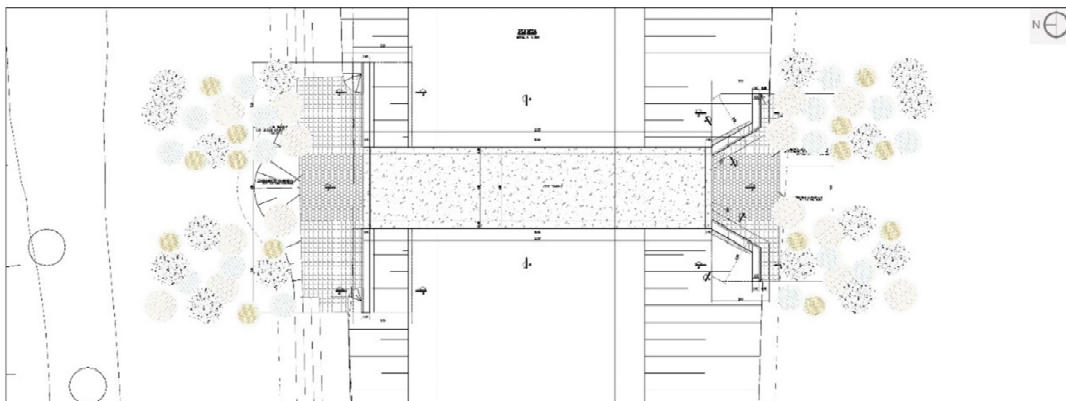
Planimetria, sesto di impianto e sezione tipologica sottopasso faunistico e vegetazione di invito
